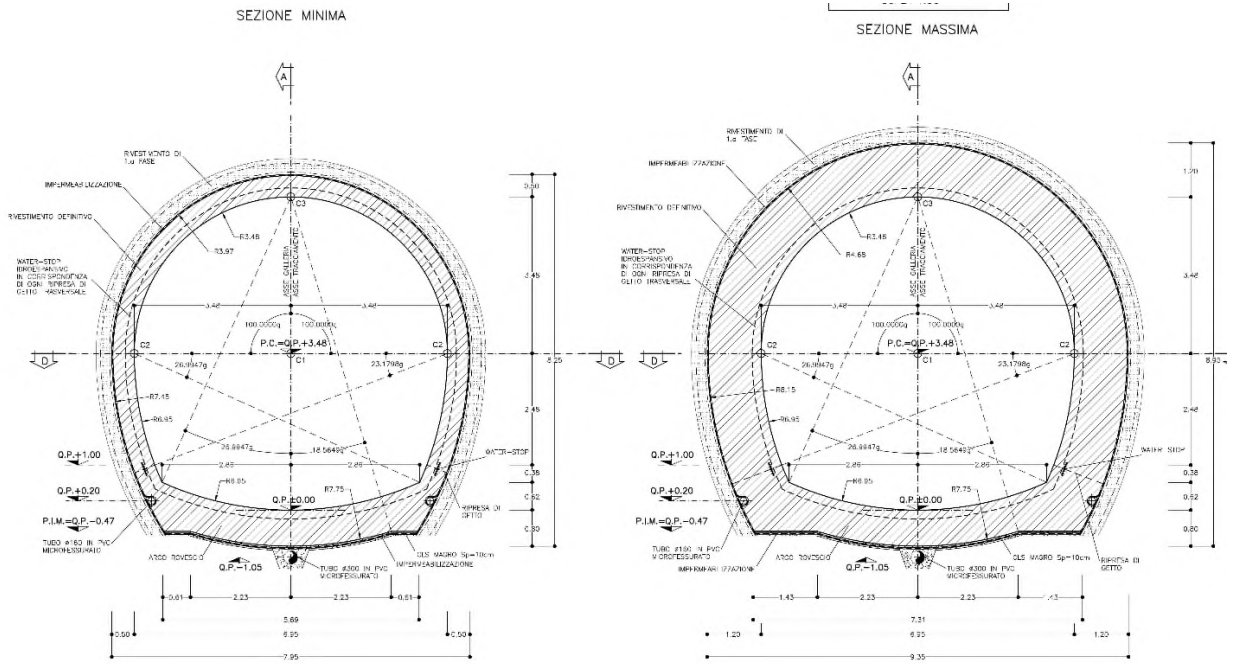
Sezione Tipo B2VP – Carpenteria – Sezioni
